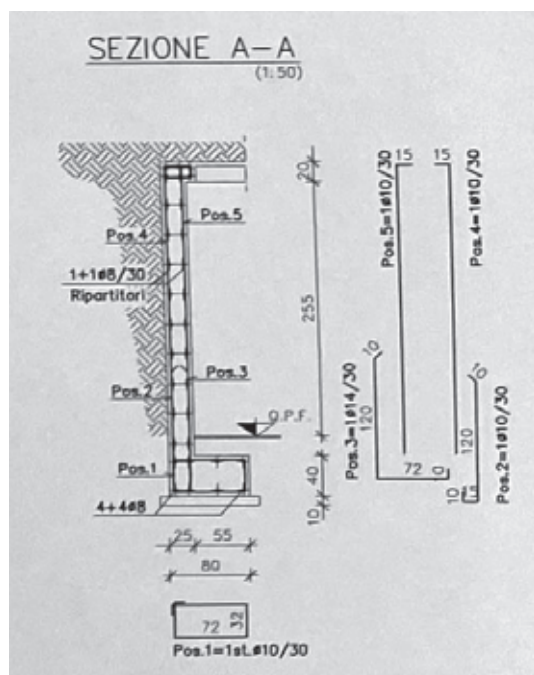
Sezione con dettagli muro contro terra in c.a.
